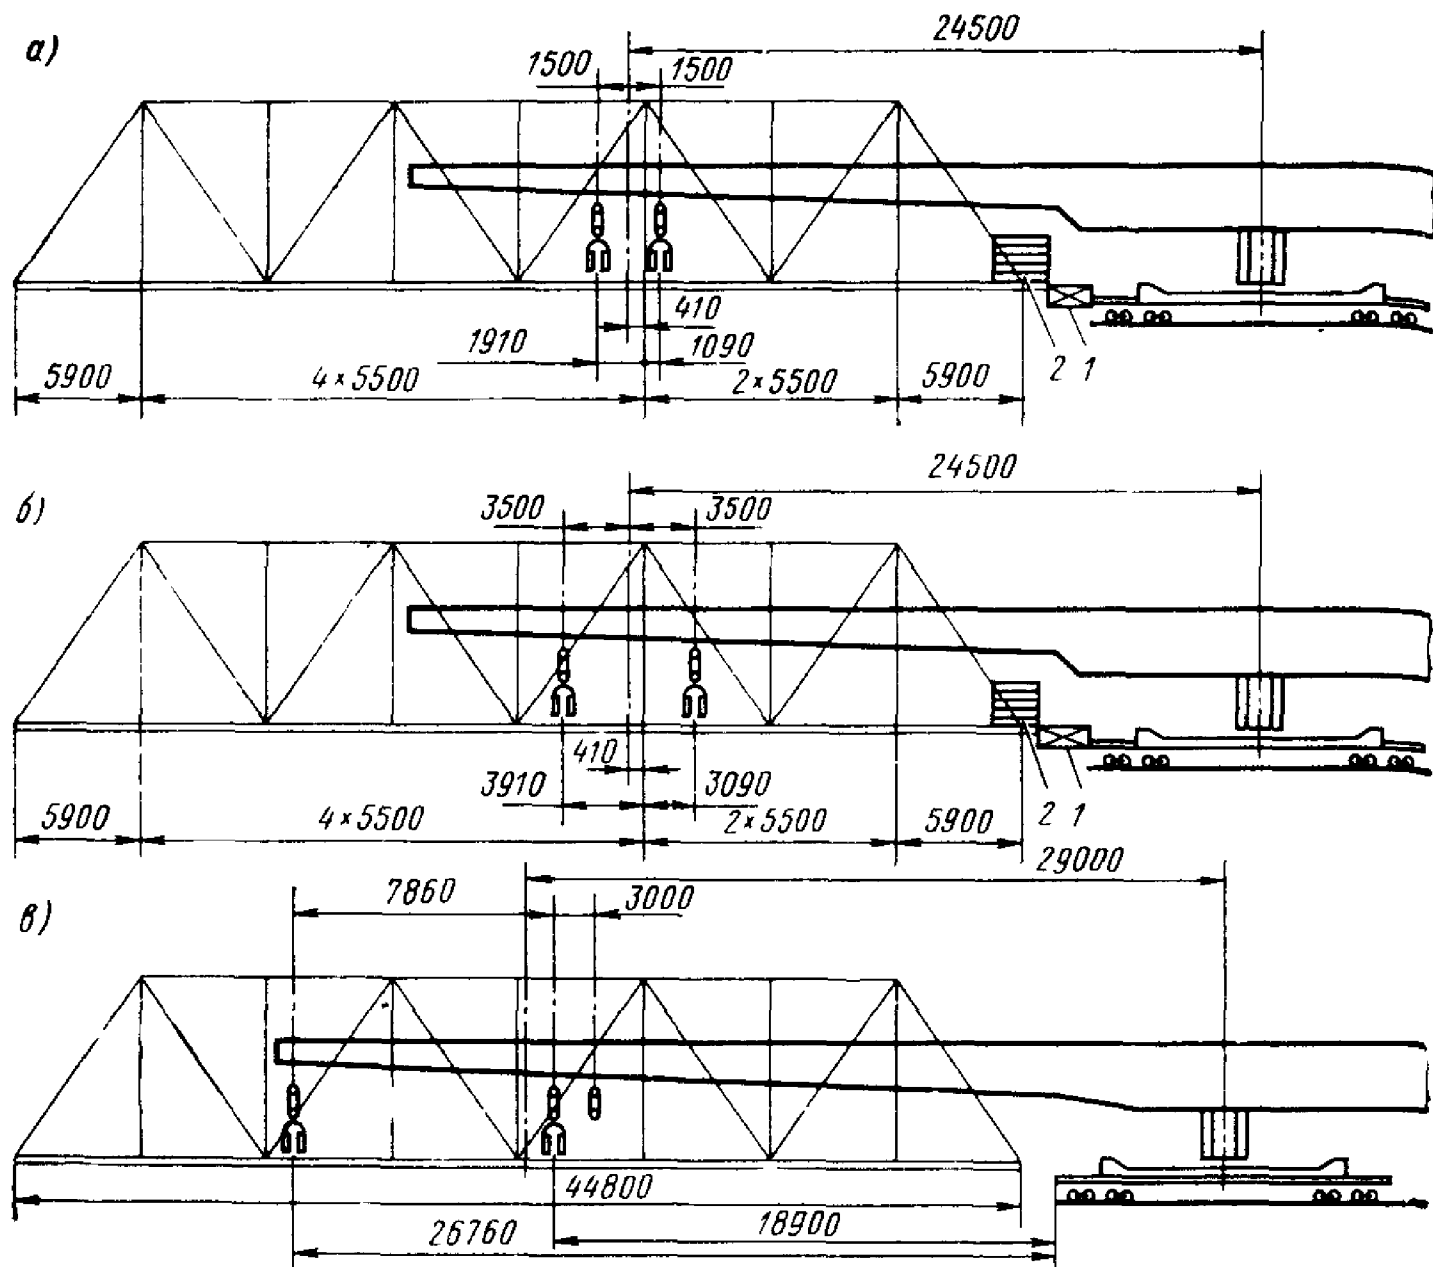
Схема строповки пролетного строения 44,8 м реконструированным краном ГЭПК-130-17,5 и ГЭПК-130У:
